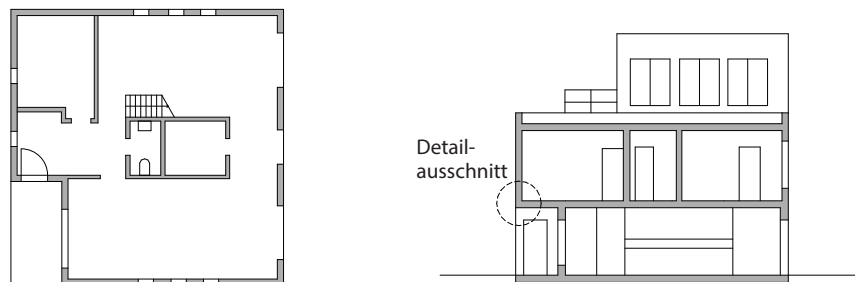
Grundriss und Schnitt - Einfamilienhaus 145 m² Bruttogeschossfläche
